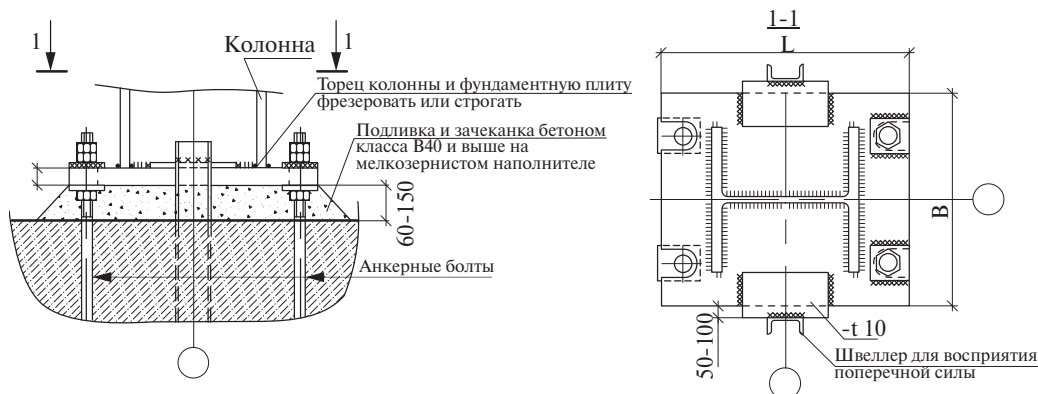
Жёсткий узел крепления колонны к фундаменту
